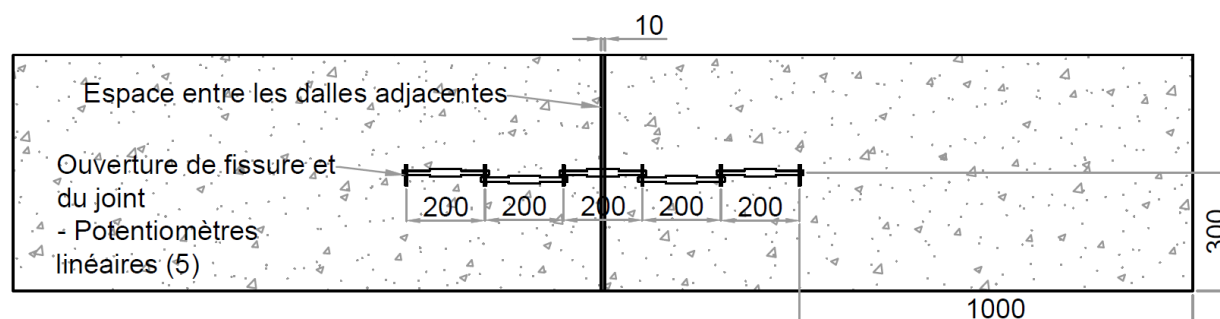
Plan d'instrumentation – Vue inférieure de la dalle avec joint de connexion longitudinal
